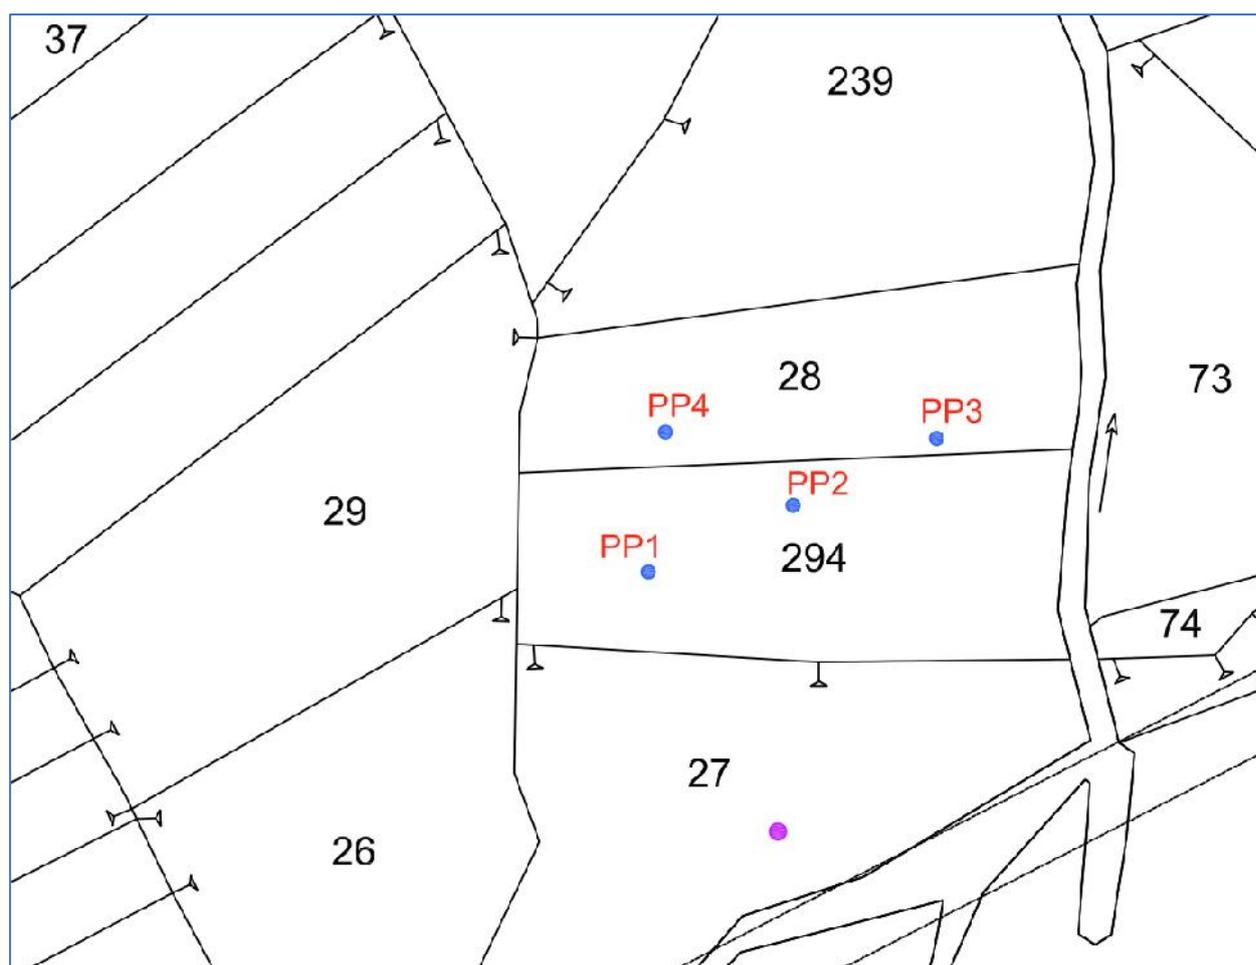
Planimetria con ubicazione delle indagini in situ
